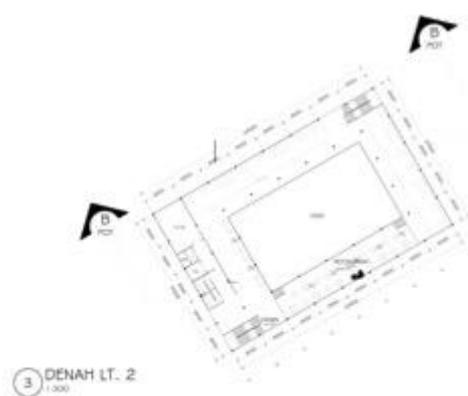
Tatanan massa, terlihat dari layout plan. Sumber: penulis.
